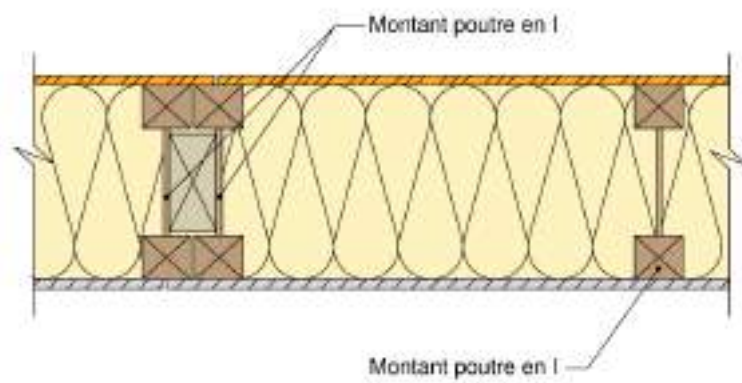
Liaison entre éléments de murs préfabriqués dans le même plan avec montants d'extrémité poutre en I
